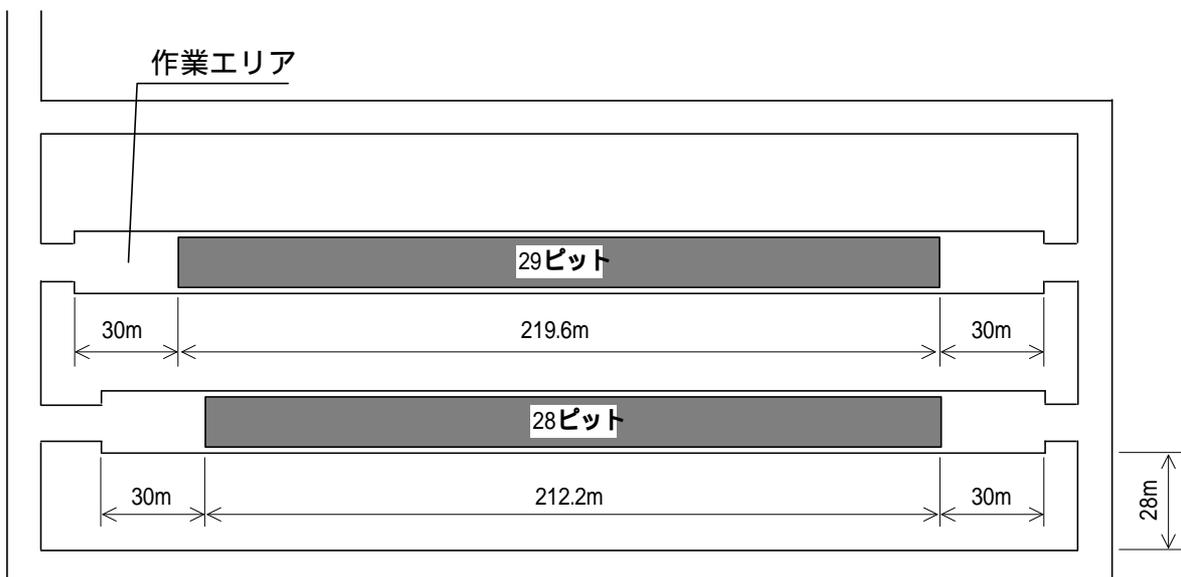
処分施設平面配置図（トンネル型施設）
